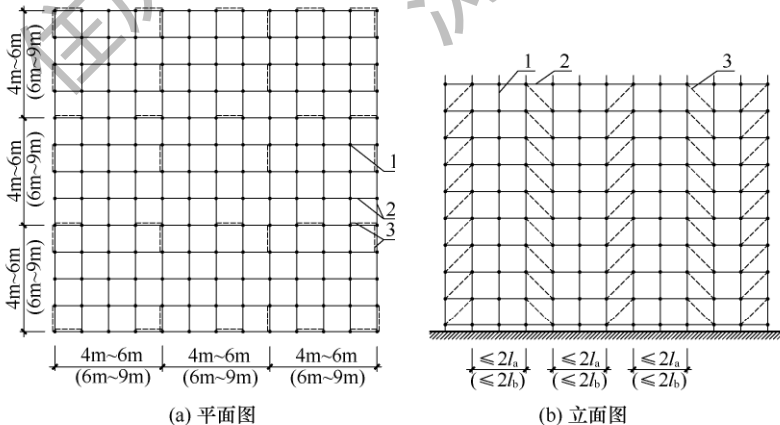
竖向斜撑杆布置示意图 (一)
